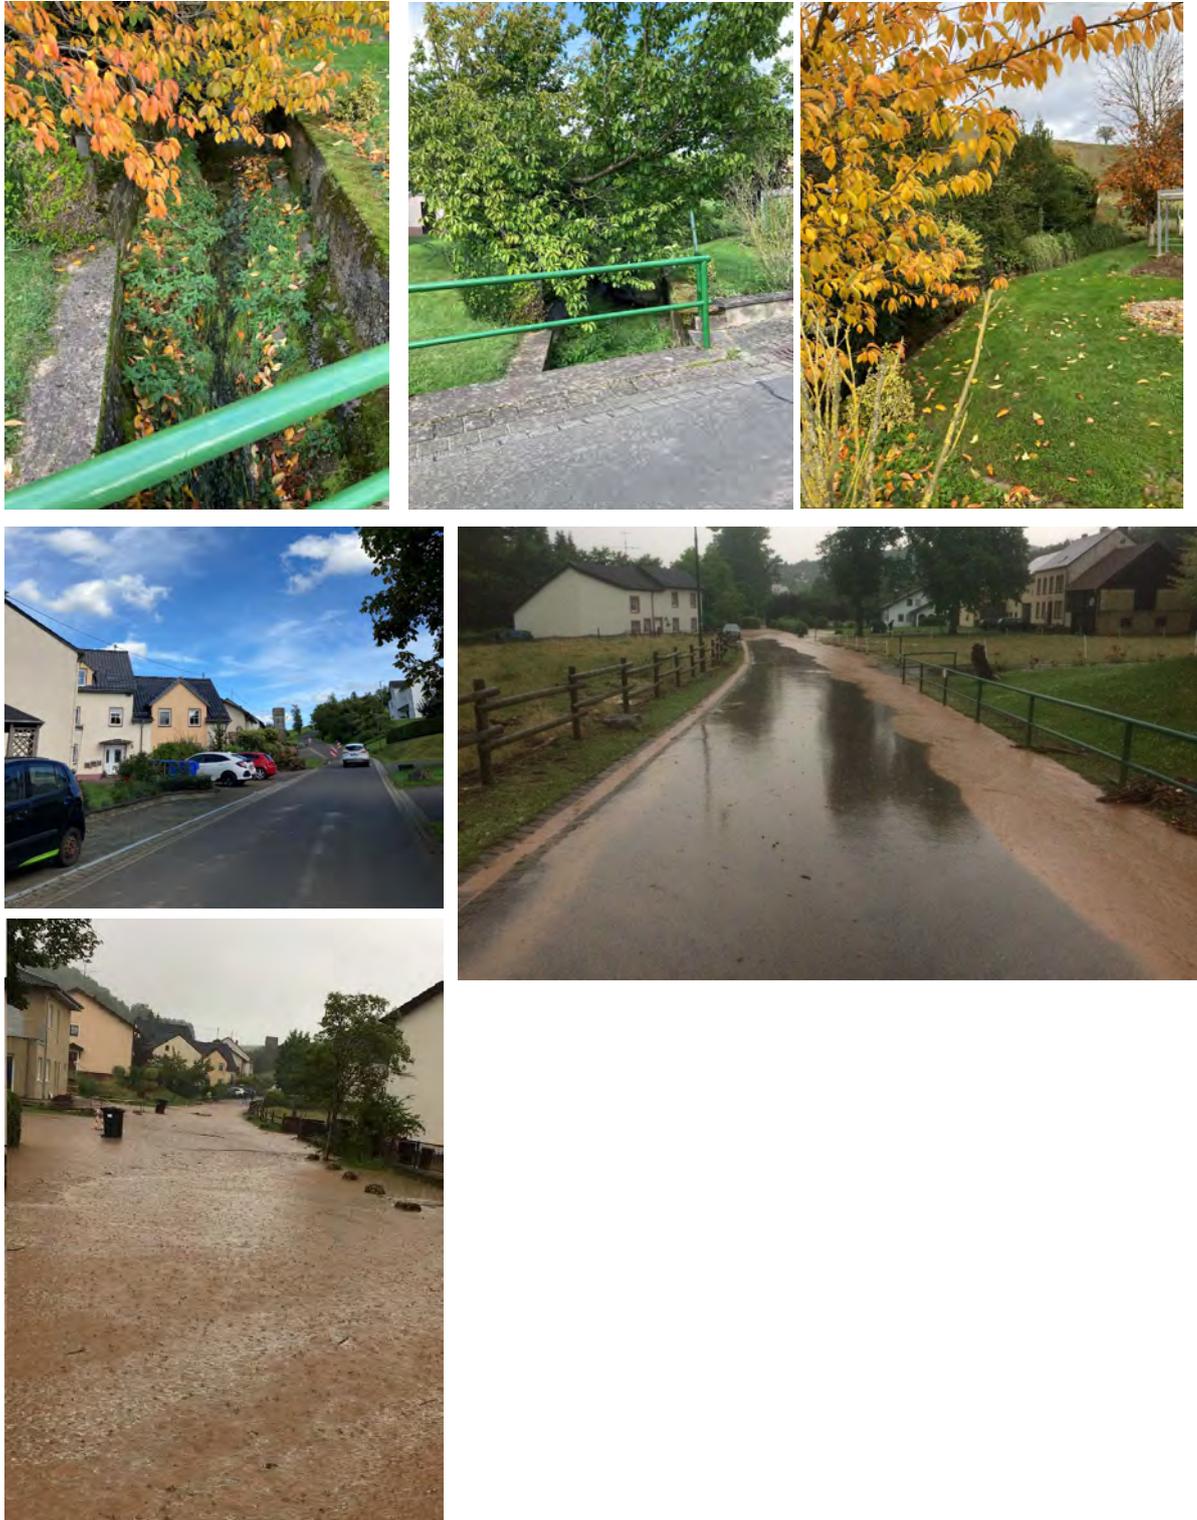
Impressionen des Espichbach mit Treibgutfängen, Einlaufbauwerken, Verrohrungen
